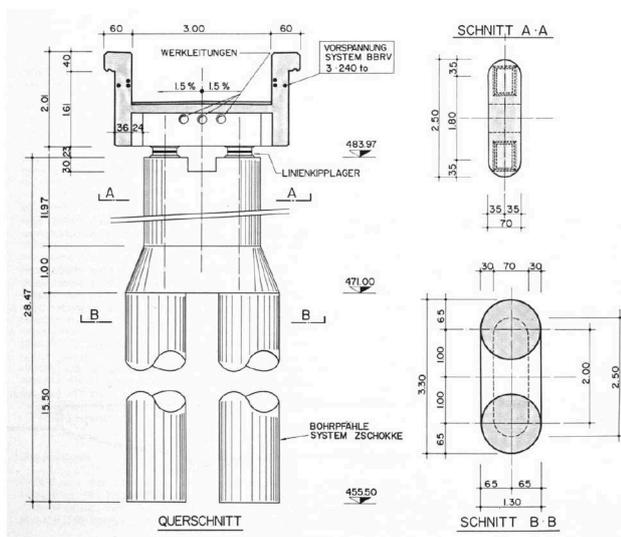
Querschnitt des Betonstegs Trübbach-Mäls.
